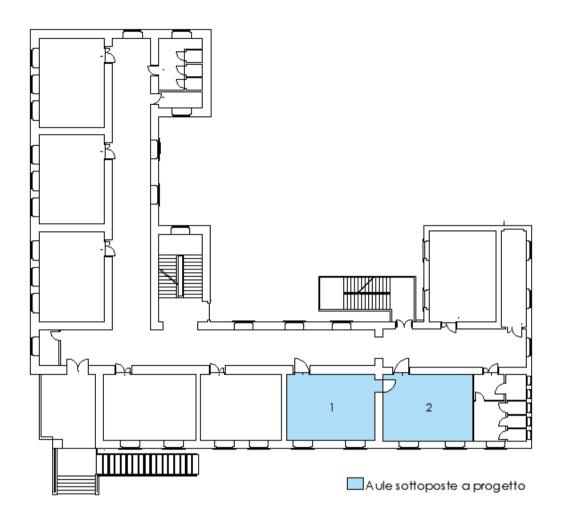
Planimetria generale piano rialzato\_plesso di via Ponte, scuola primaria
